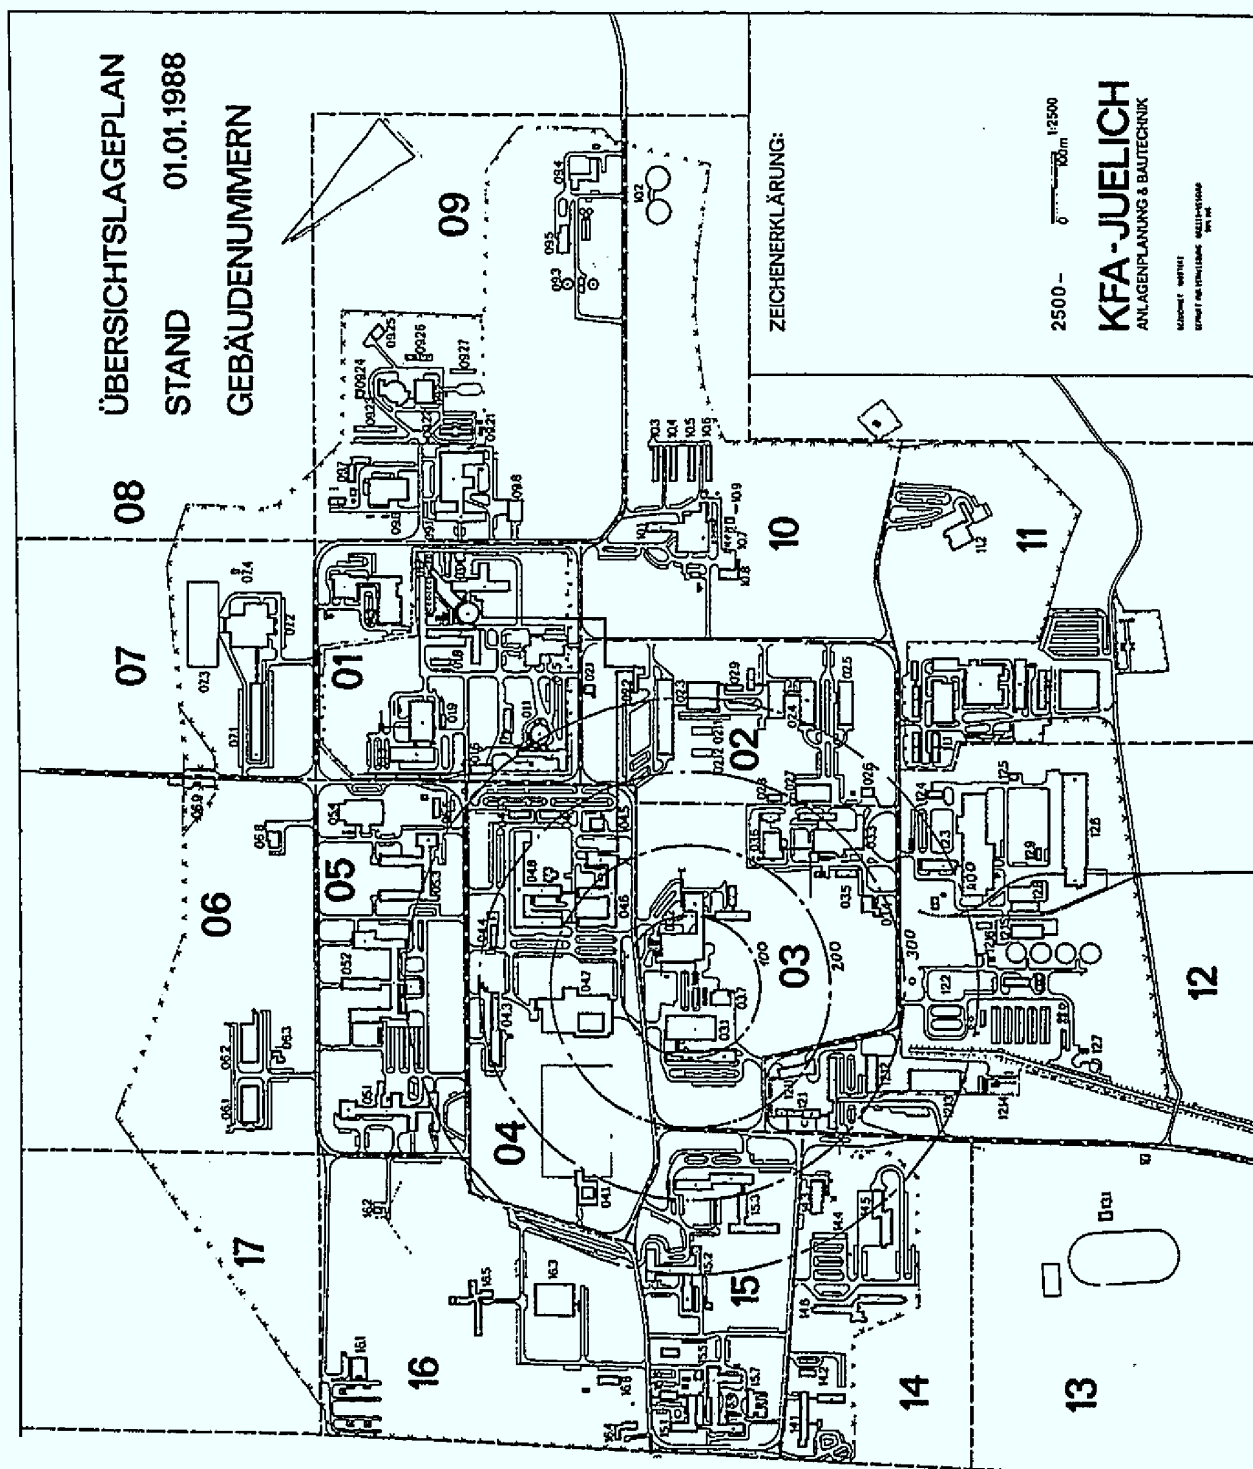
KFA-Lageplan mit Entfernungsradien
